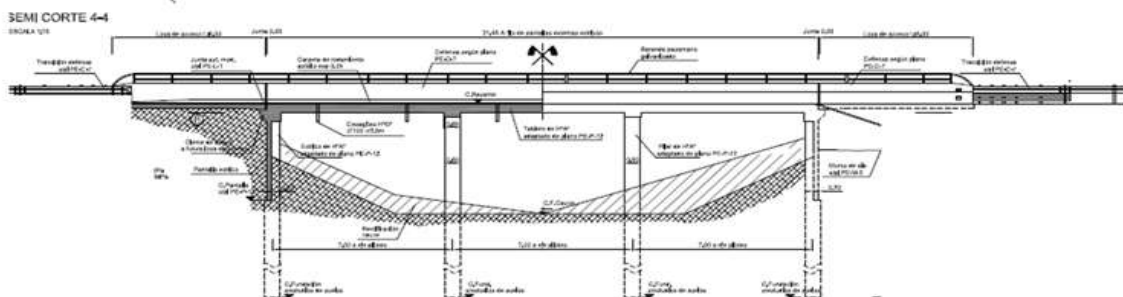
Reemplazo del puente sobre Arroyo Aguirre PR 0+000
